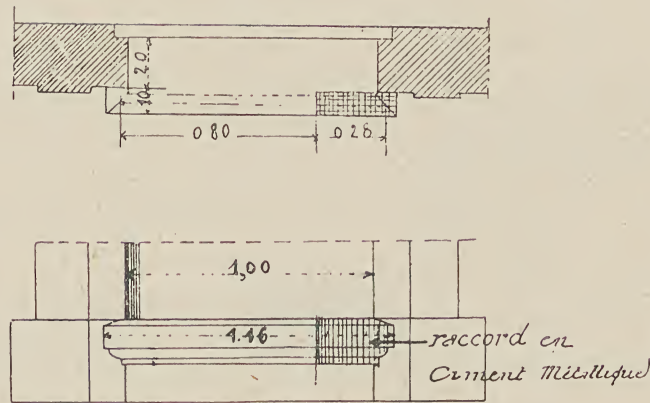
et 71. — Plan et élévation d'un appui en pierre ravalé et restauré en ciment métallique.
